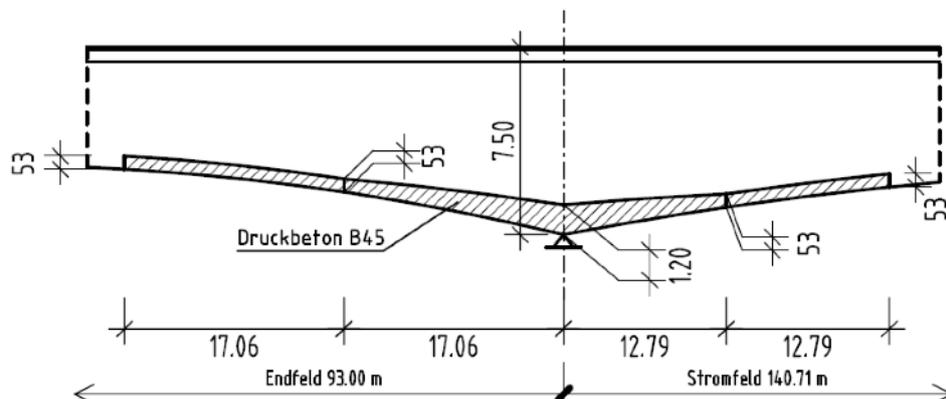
Ausführungsbeispiel für Doppelverbund mit Druckbeton im Kastenboden
